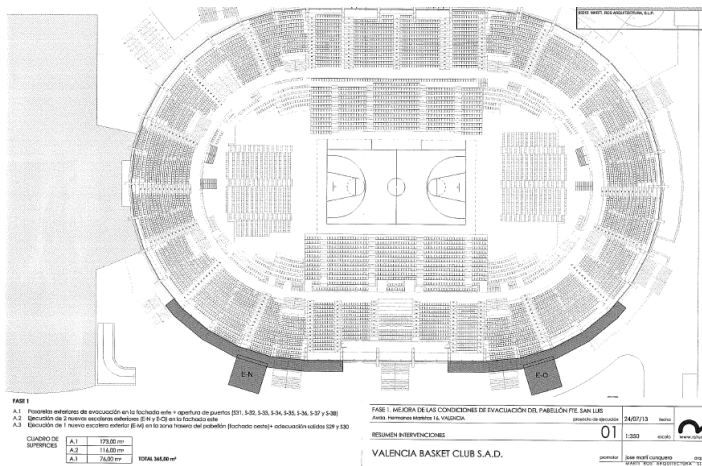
Plano de Situación de Intervenciones. Plano 21.
